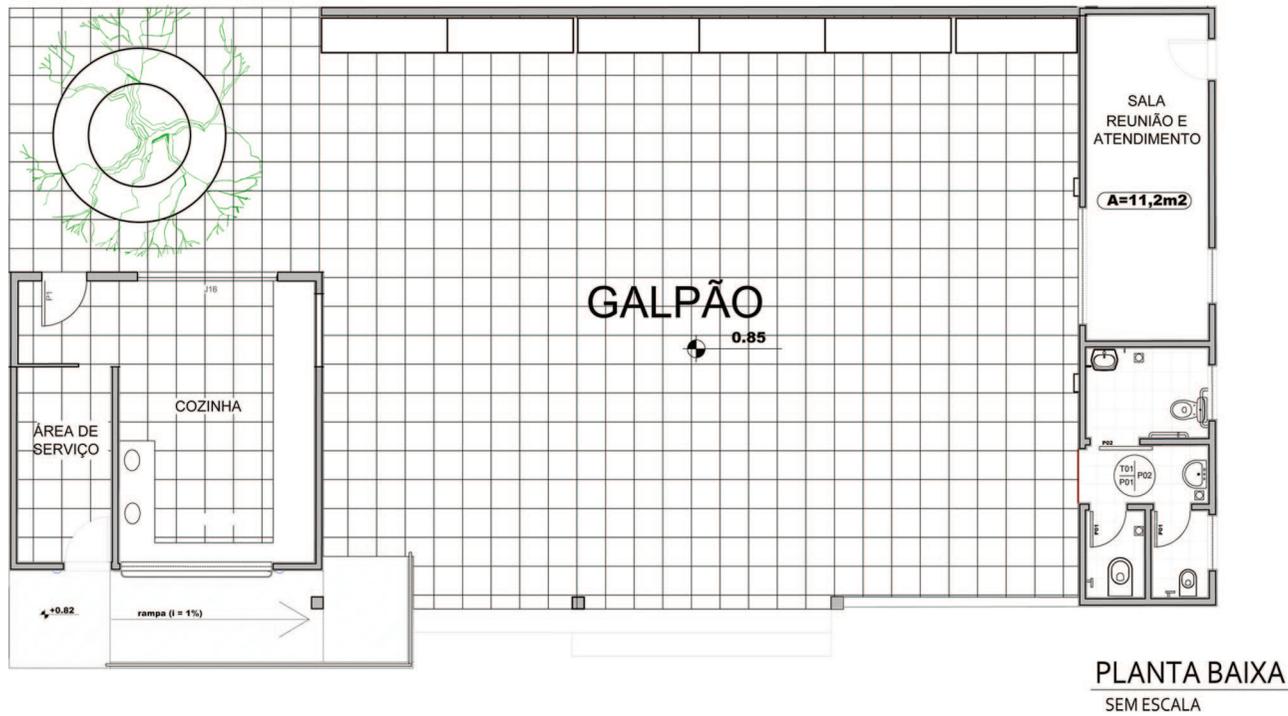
planta baixa da cozinha, galpão e banheiros coletivos
